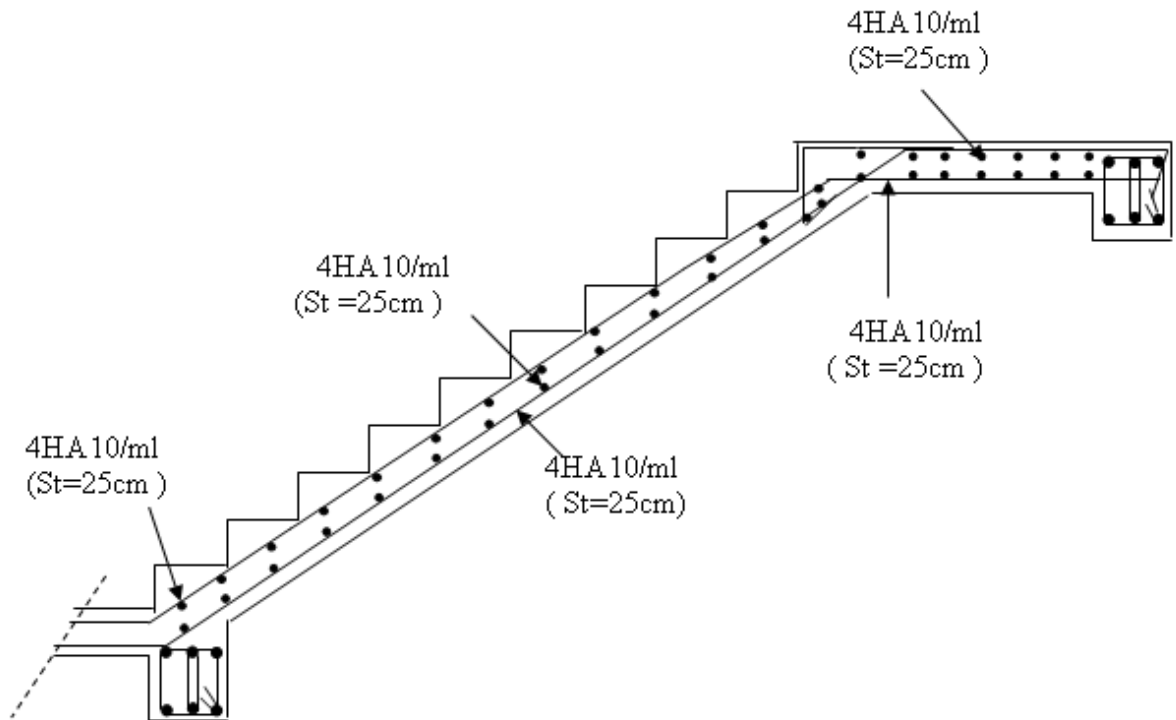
FERRAILAGE DE L'ESCALIER
